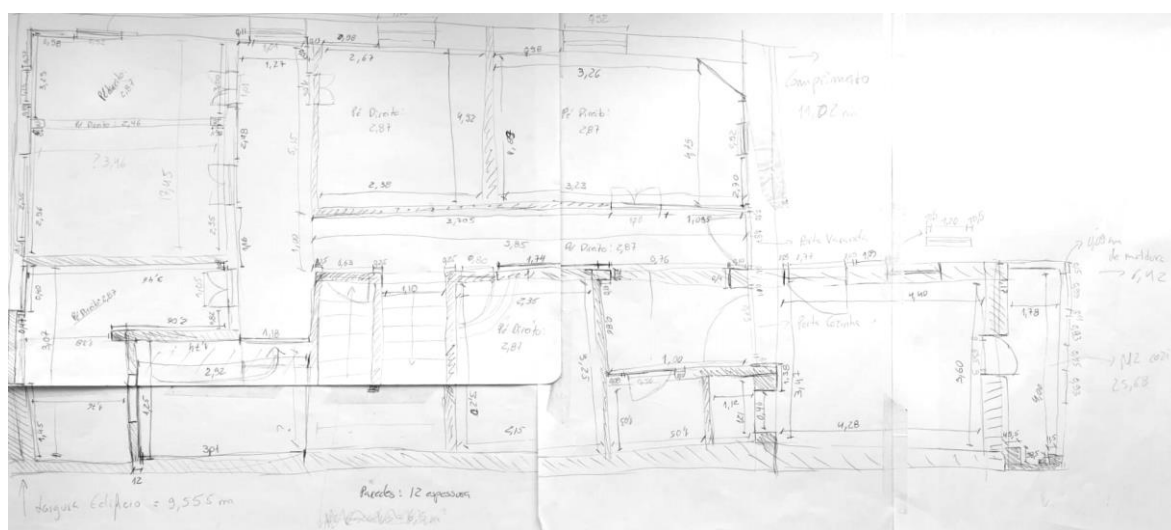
Esboço de planta do piso 1. Fonte: Ana Ferreira
